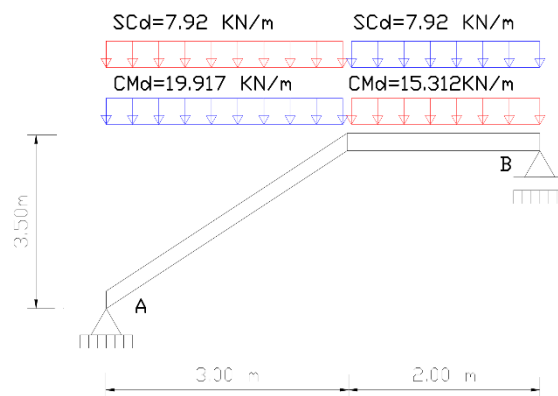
Consideración de la escalera para el cálculo de la armadura principal.
